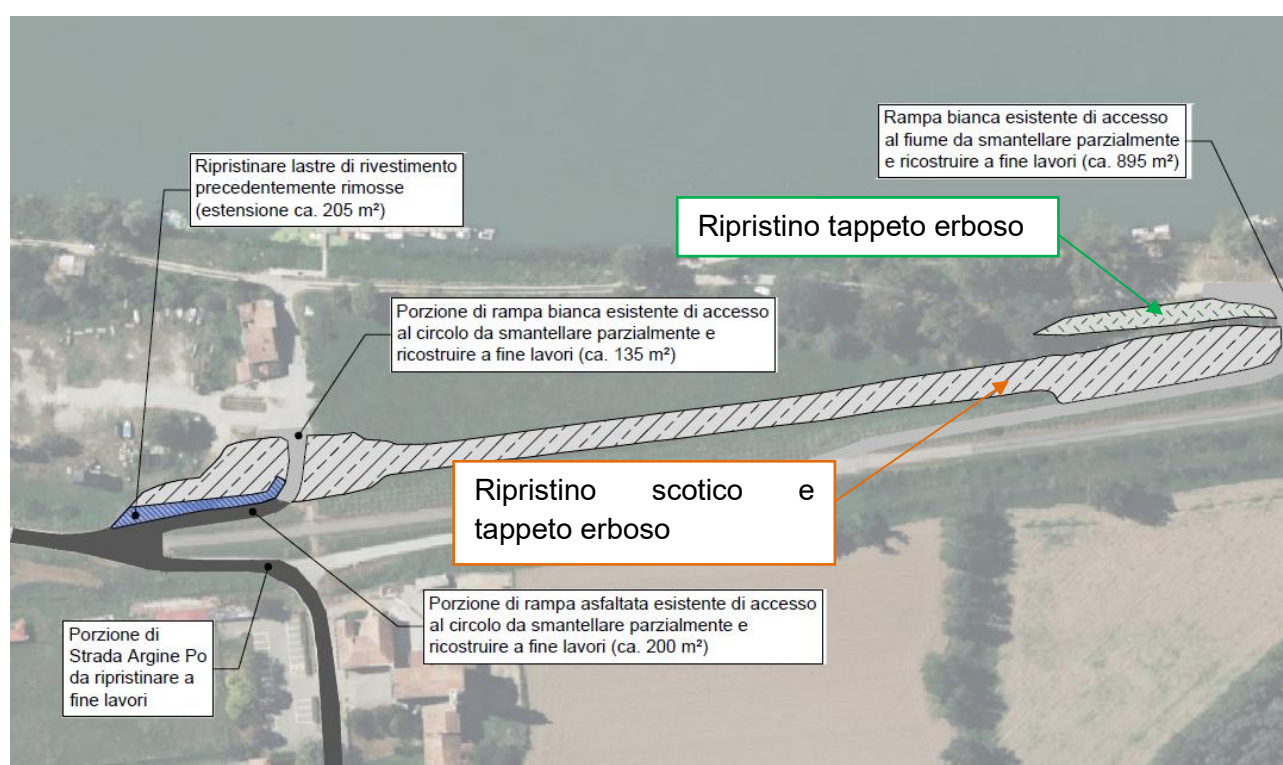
Estratto dalla tavola PE.0.1.6.PR.GE.P.L.0.0.4 "Planimetria ripristini finali" – area sud Caorso.
